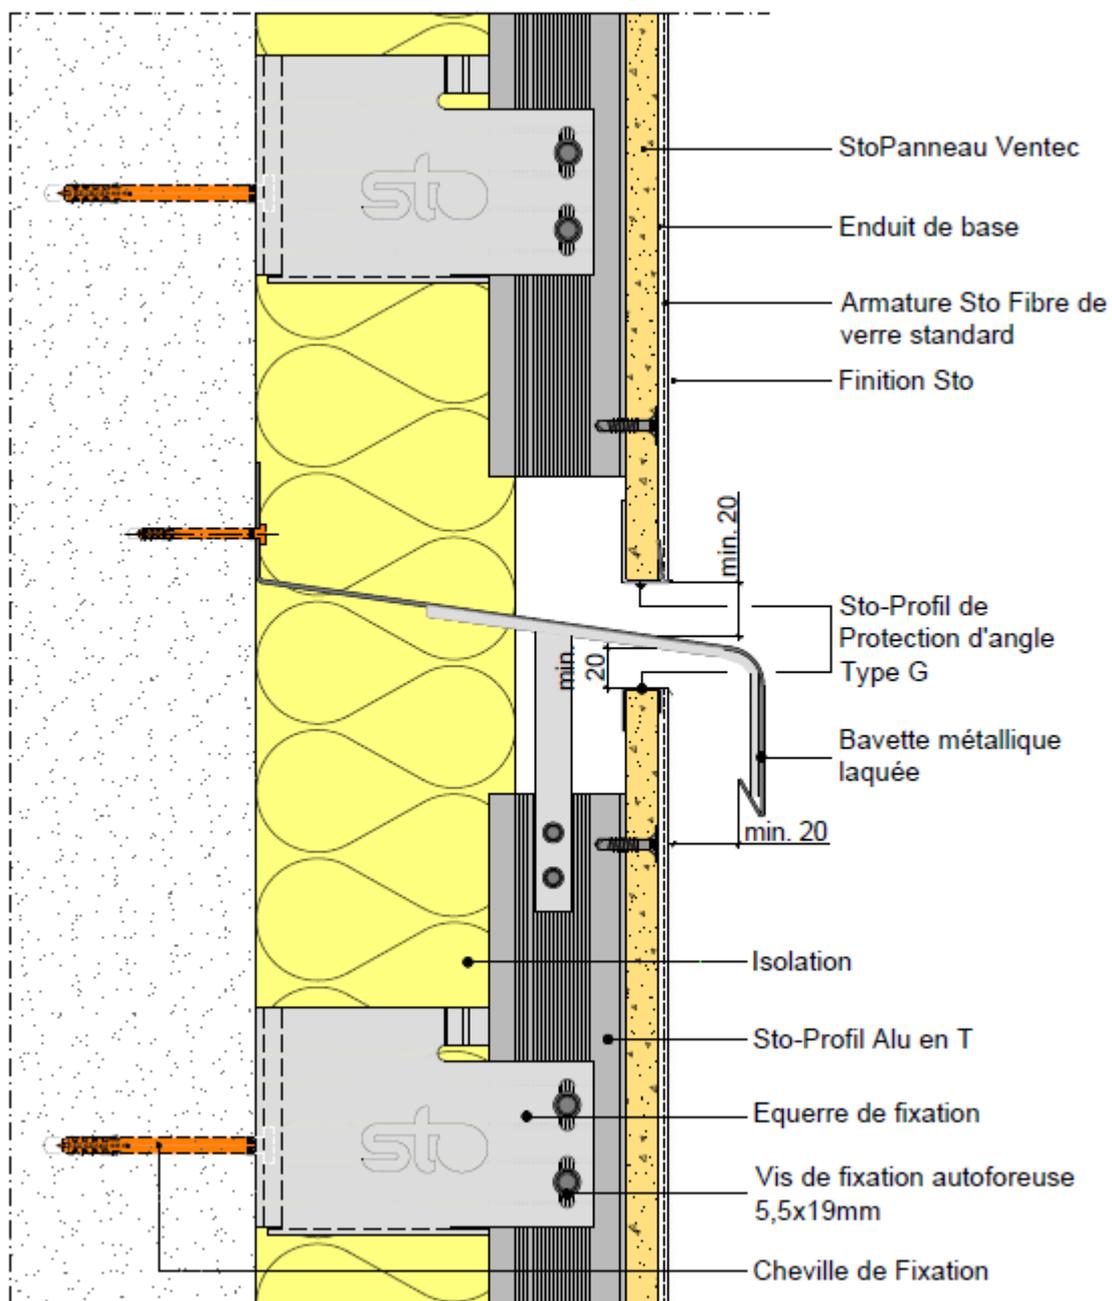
Coupe verticale - Fractionnement du système - Recouvrement de lame d'air
